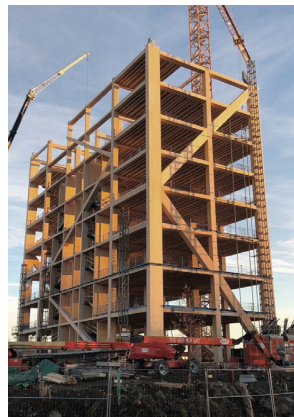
Imagen fase construcción 2. Estructura y forjados. CLT, GLT y VLV.
